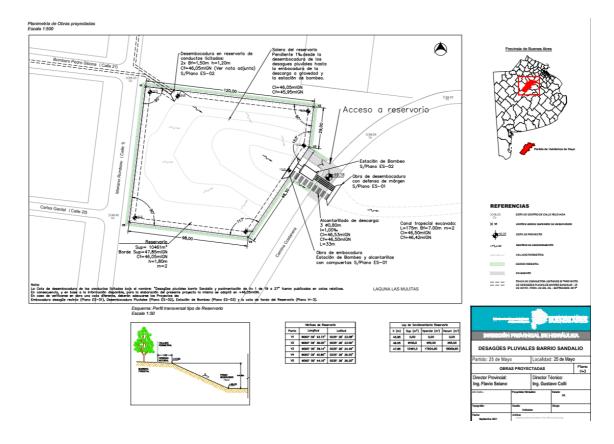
Plano general de obras proyectadas. Plano PL3 (H3) Plano de obra.
